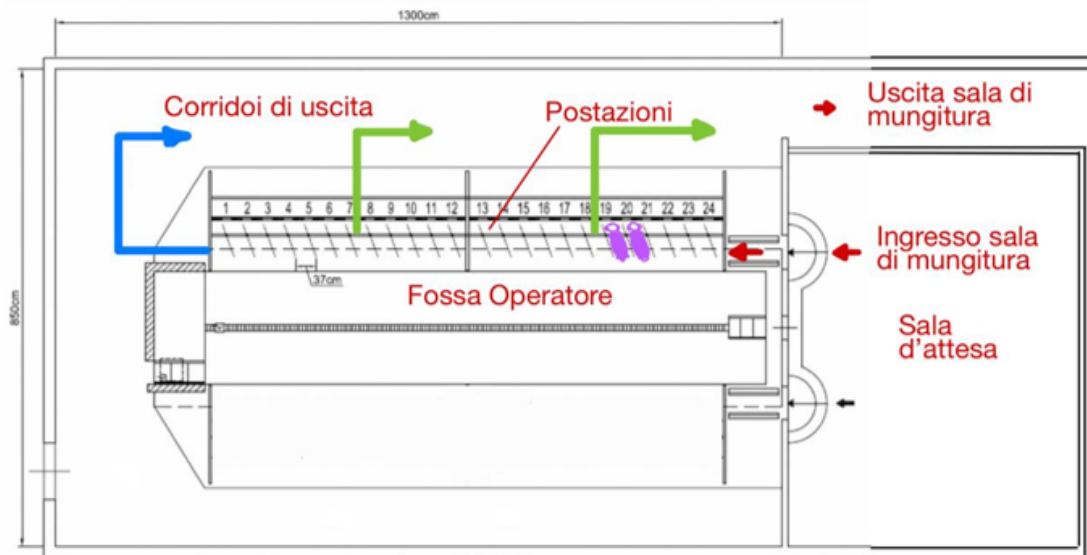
Planimetria di un locale di mungitura a 24 postazioni disposte in parallelo
